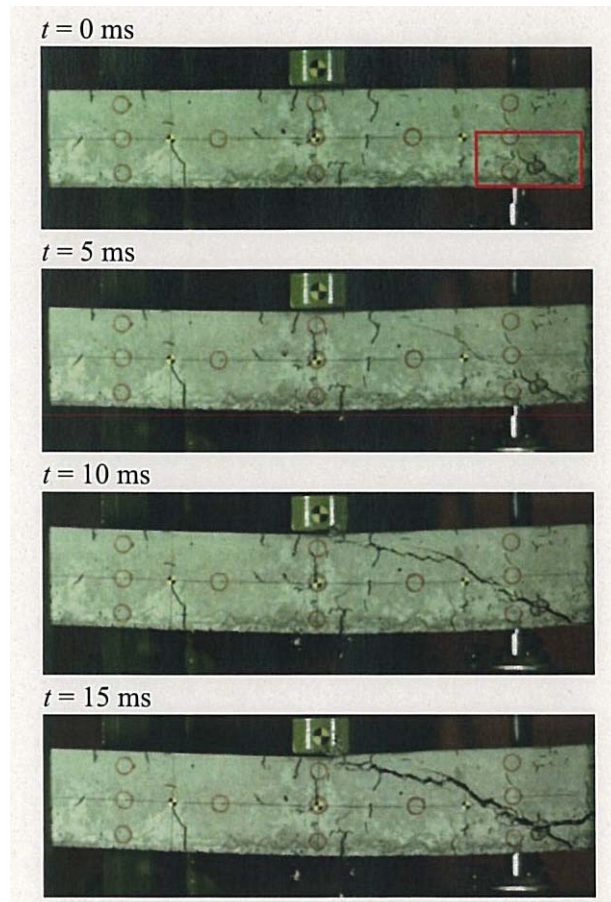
せん断破壊に至るひび割れ分布の推移状況 (D81-IS 試験体)
